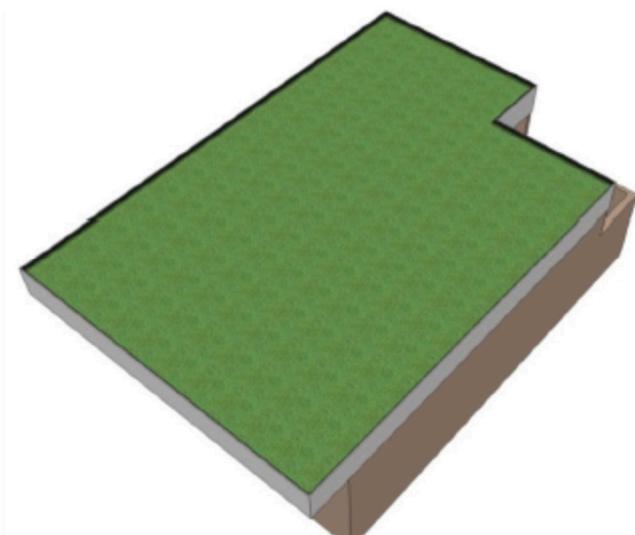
Telhado verde vernacular vegetado com laje pré-moldada.
